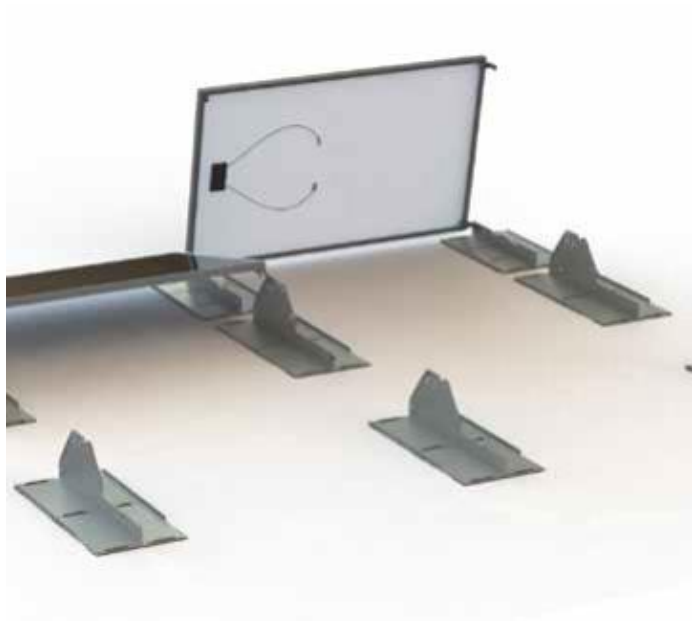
Střešní konstrukce EAST WEST TEGRA
